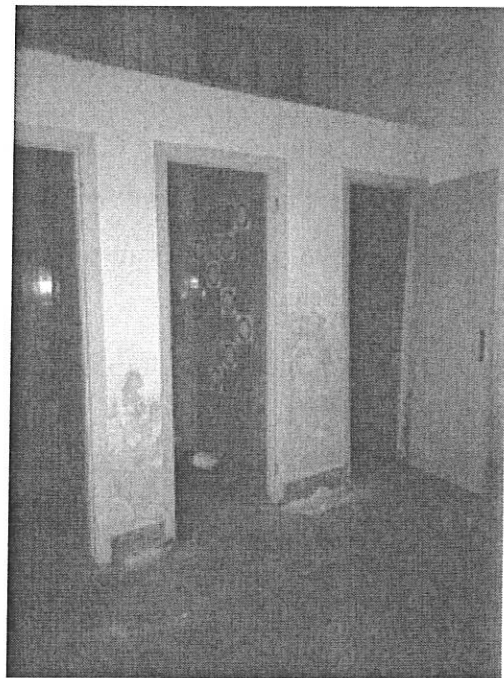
interni – area soppalcata con struttura metallica; Foto 10/12: interni – ampio locale pilastrato;
